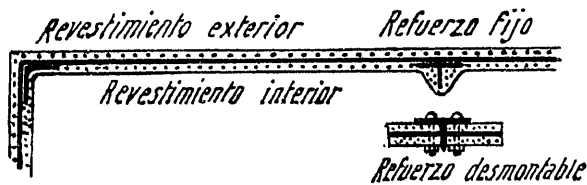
Sección horizontal de un muro de «Torkret» con alma de plancha de palastro, lisa.
